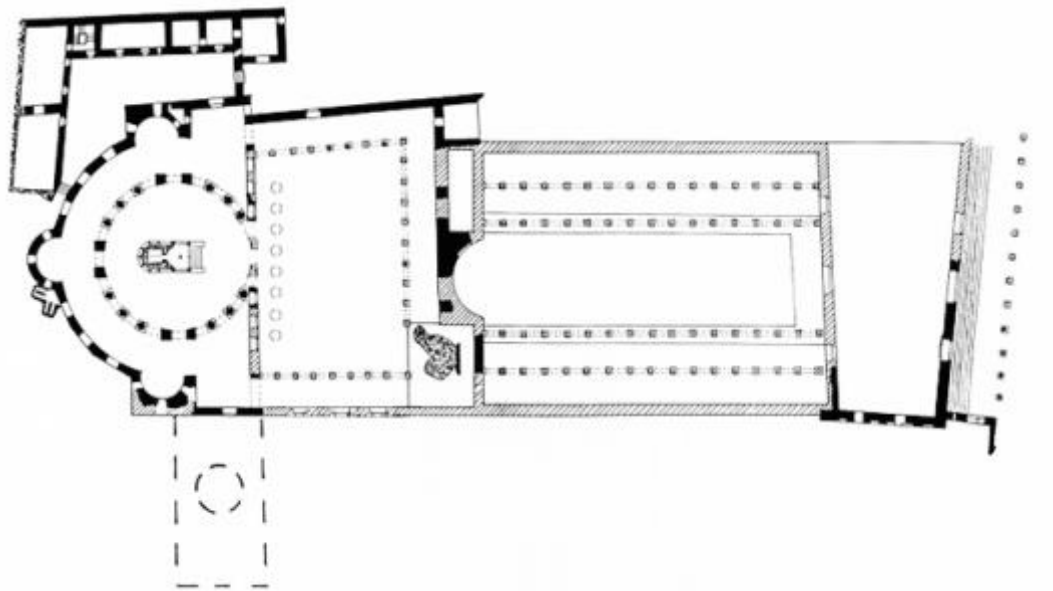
Planta de la Basílica del Santo Sepulcro en el siglo IV.
